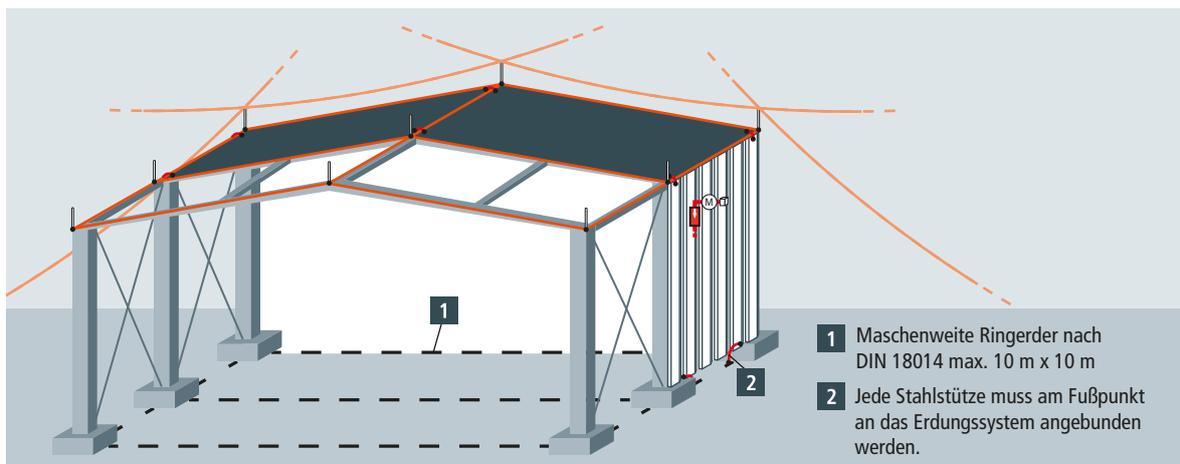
Stahlhalle mit Metallverkleidung sowie installierter Fangeinrichtung auf dem Foliendach
